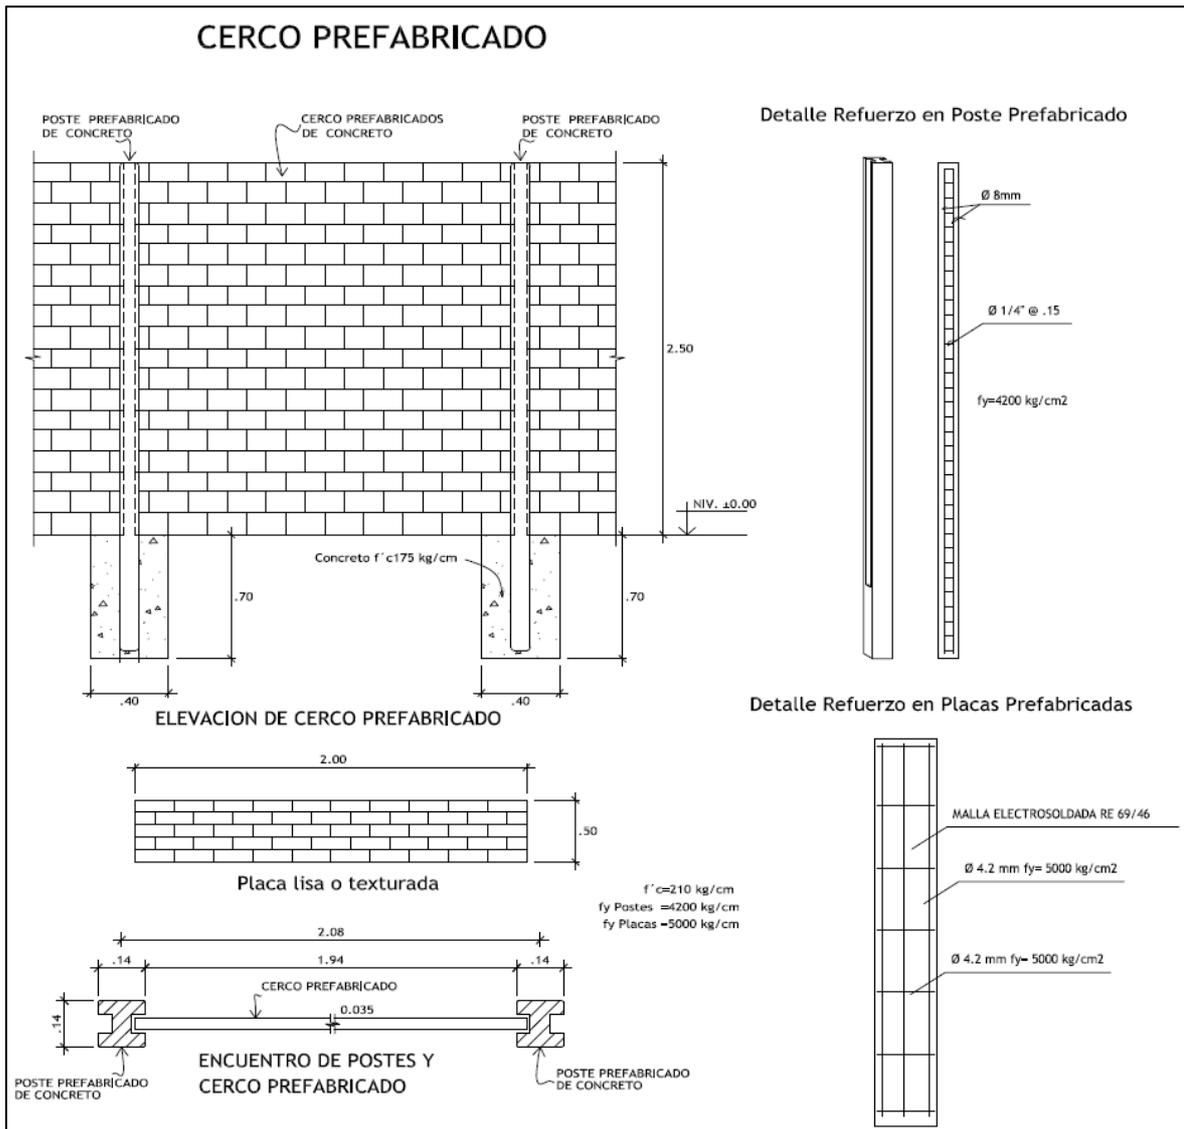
Elementos de concreto armado componentes del cerco prefabricado
